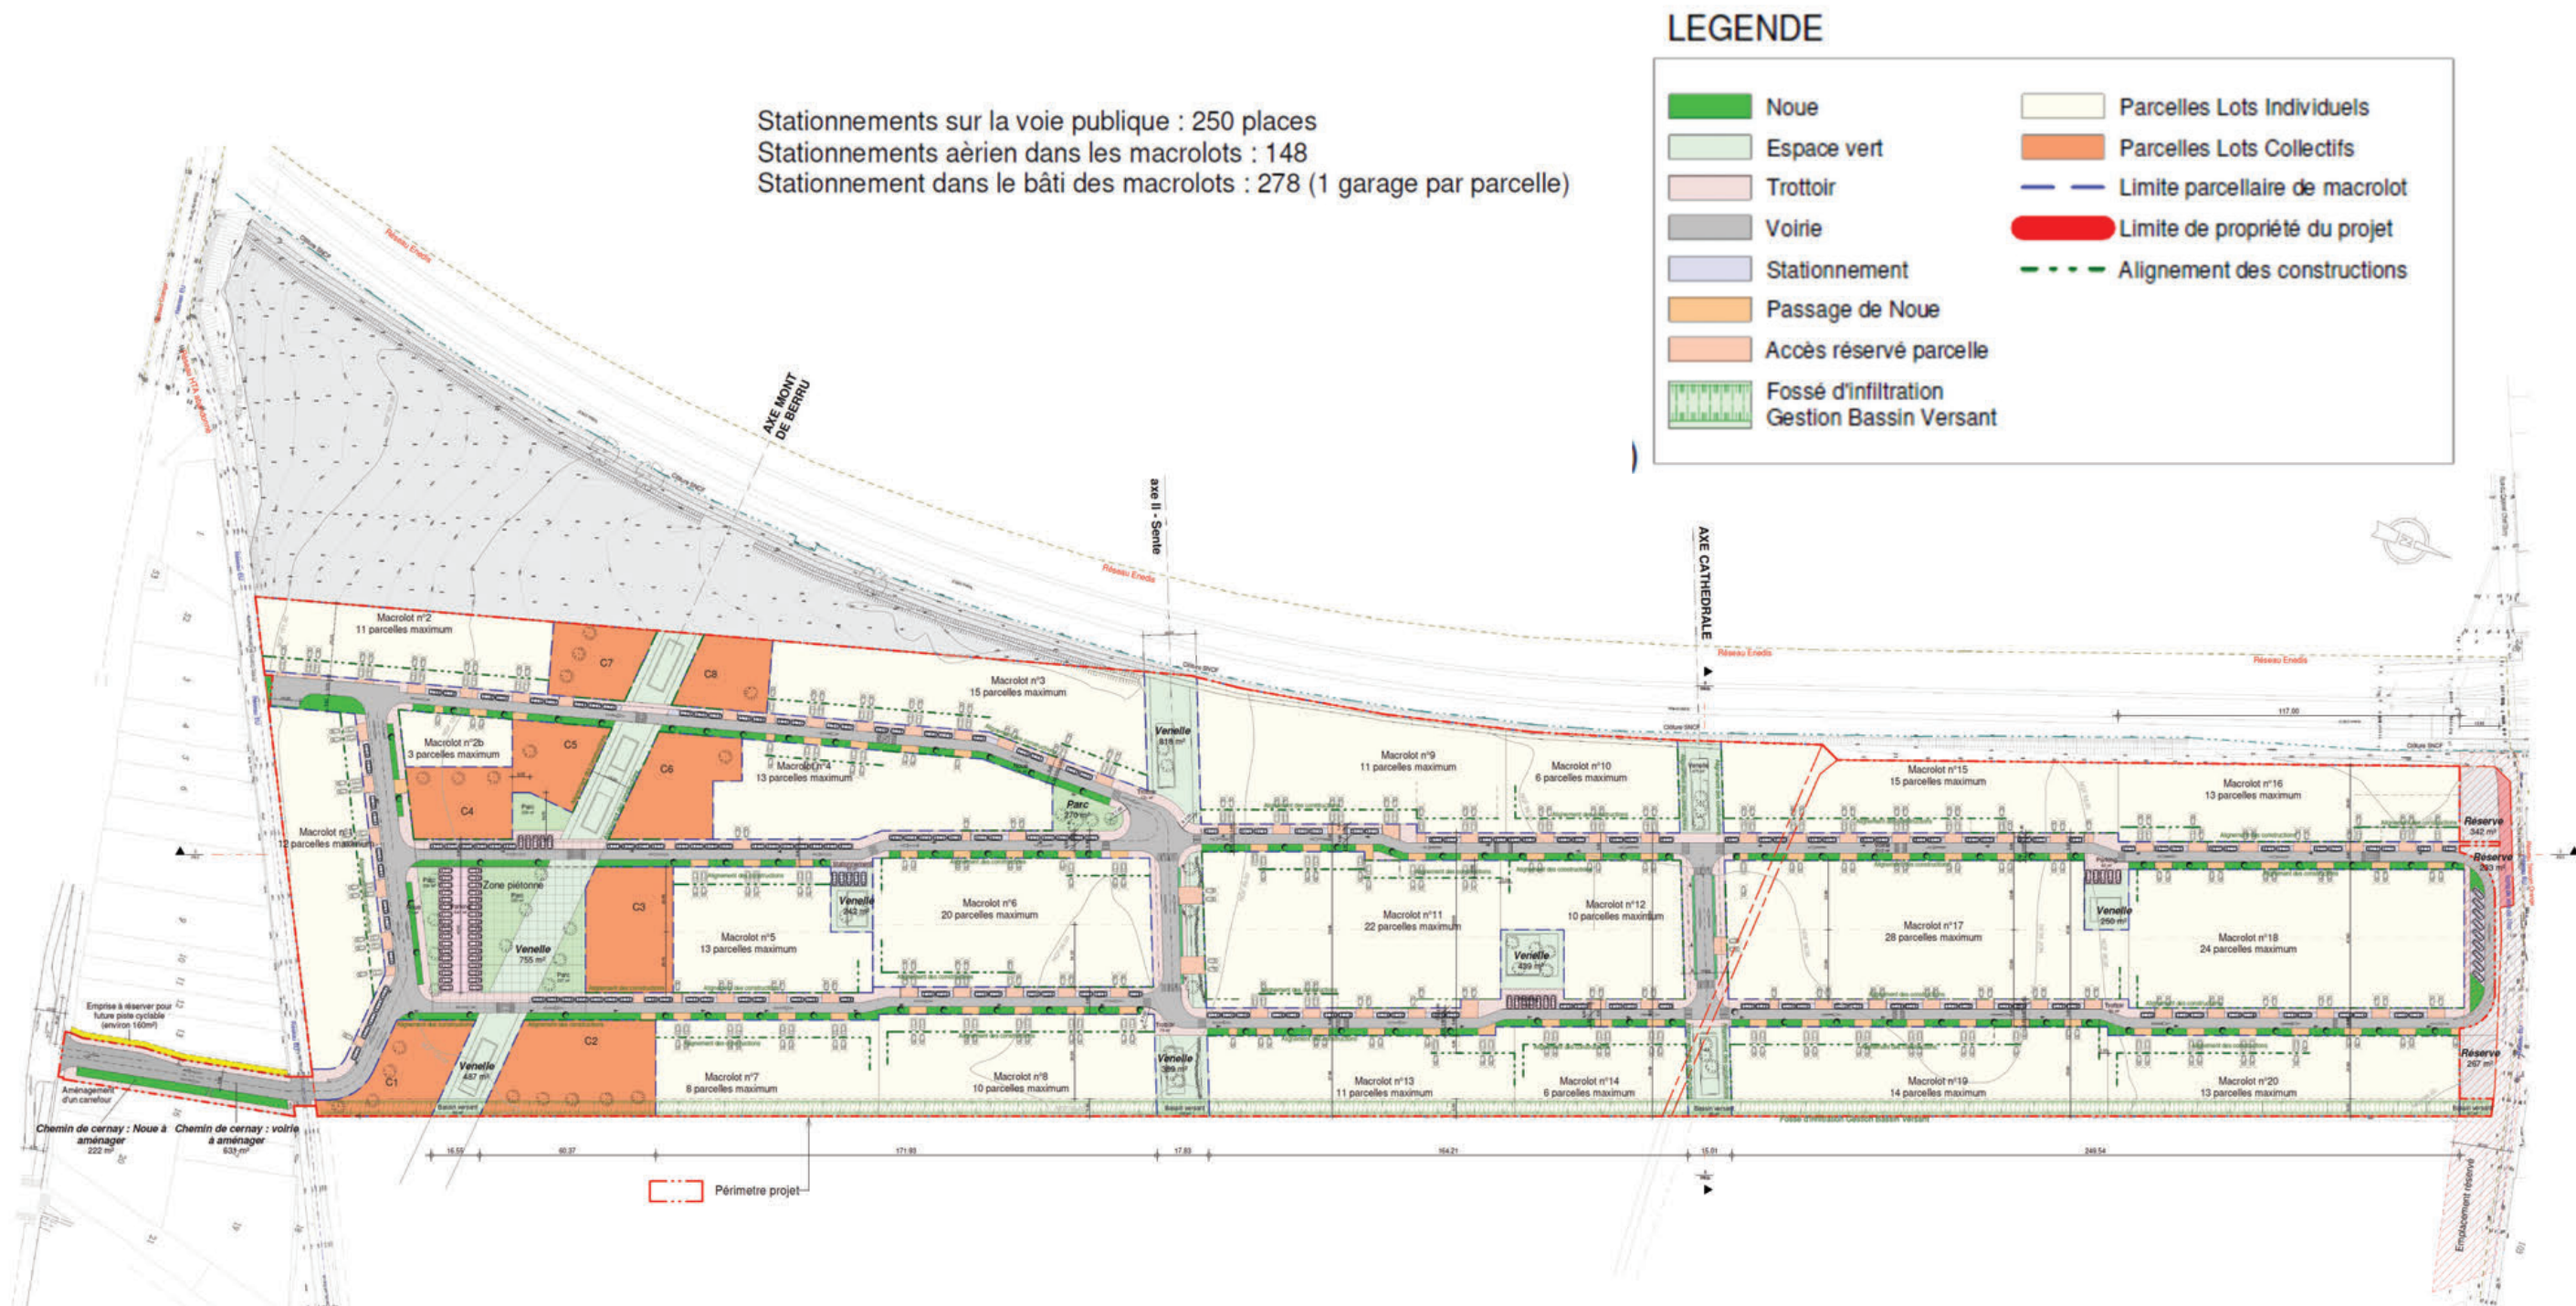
Plan masse du lotissement « Bonne Nouvelle » (AWO)
